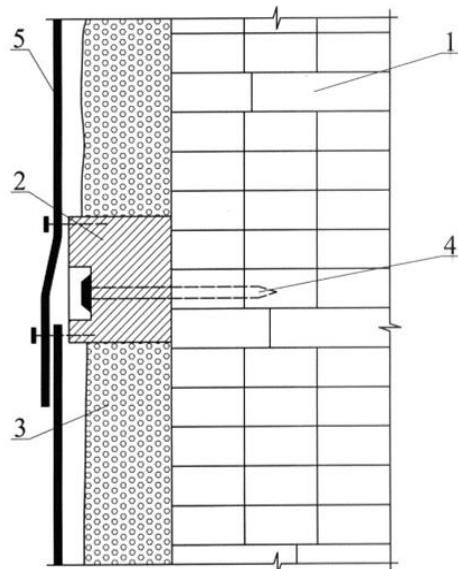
Утепление фасада плитным утеплителем по деревянному каркасу: 1 – утепляемая стена; 2 – брусок каркаса; 3 – утеплитель; 4 – анодированный или оцинкованный анкер; 5 – лист облицовки
